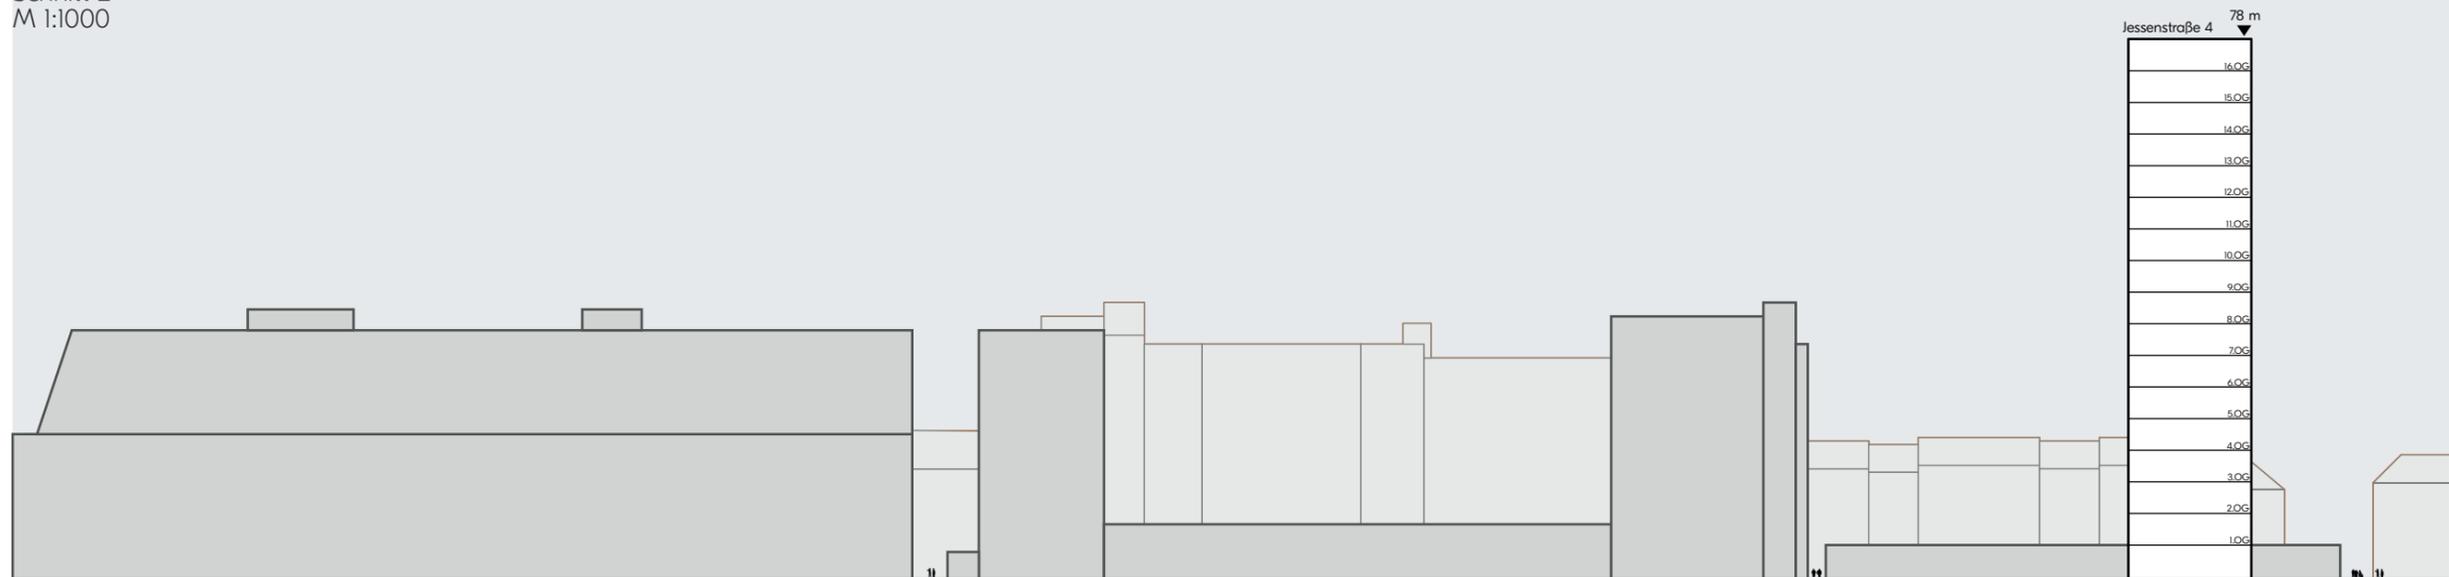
Schnitt 2 - Jessenstraße 4
